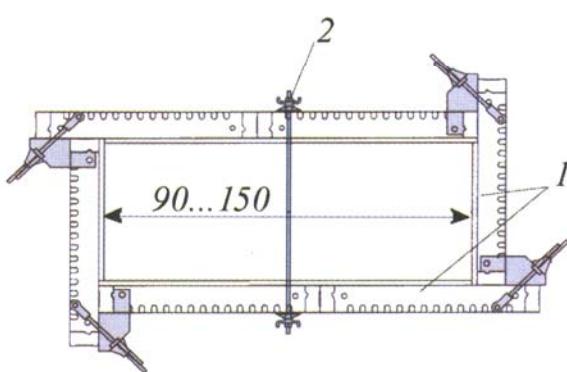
Опалубка прямоугольных колонн «HOE Vario 2000»:
